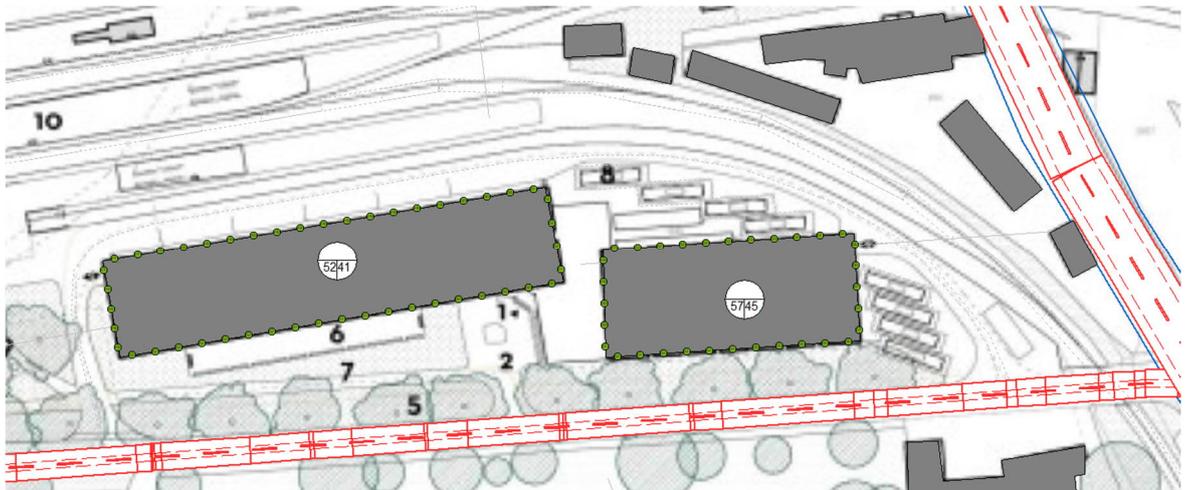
Darstellung des Lärmmodells «Strassenverkehrslärm» im Grundriss mit den beiden Hotels und den Hausbeurteilungen.
